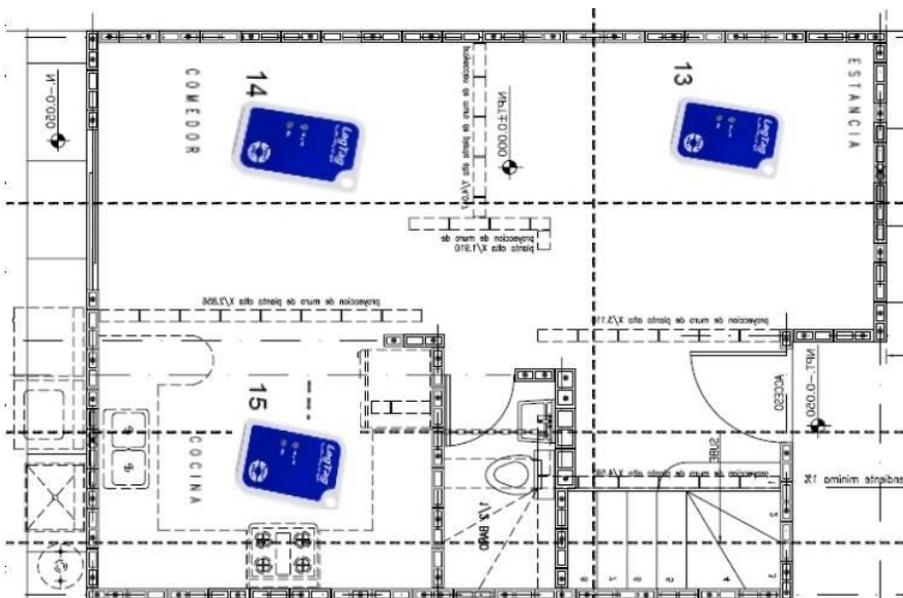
Planta arquitectónica de la vivienda tres, primer nivel. Orientada al Sur
